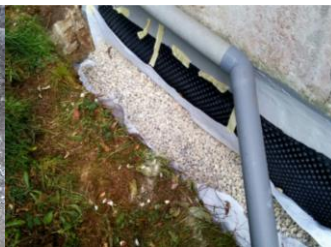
Capa drenante y filtrante de grava (A Basanta Construcciones)
